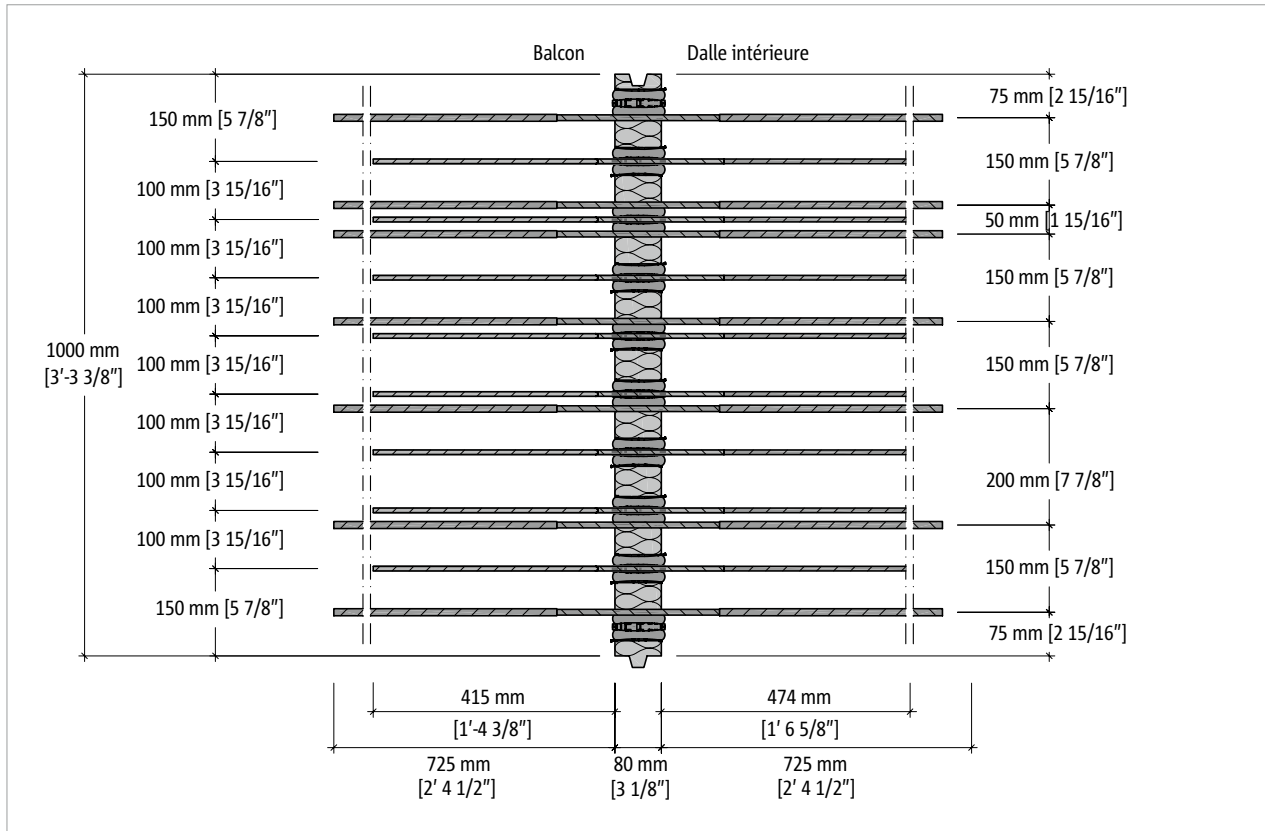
Schöck Isokorb® T Type CK-M6-V3 : vue en plan du produit
